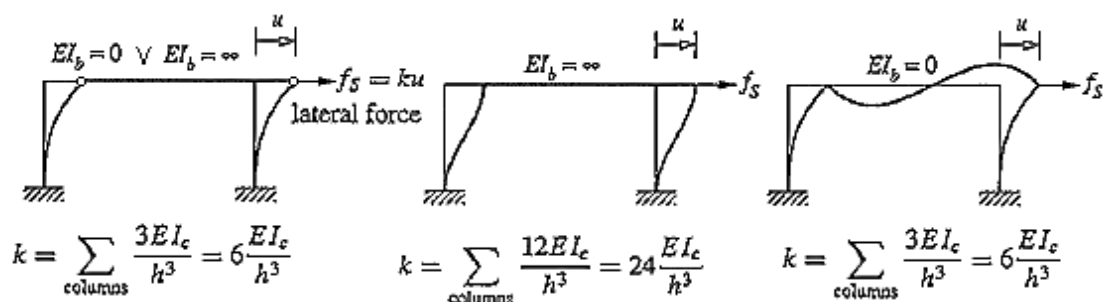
Pórtico plano com ligação viga-pilar articulada ou rígida, adaptado de (Reis A. , 2001)
